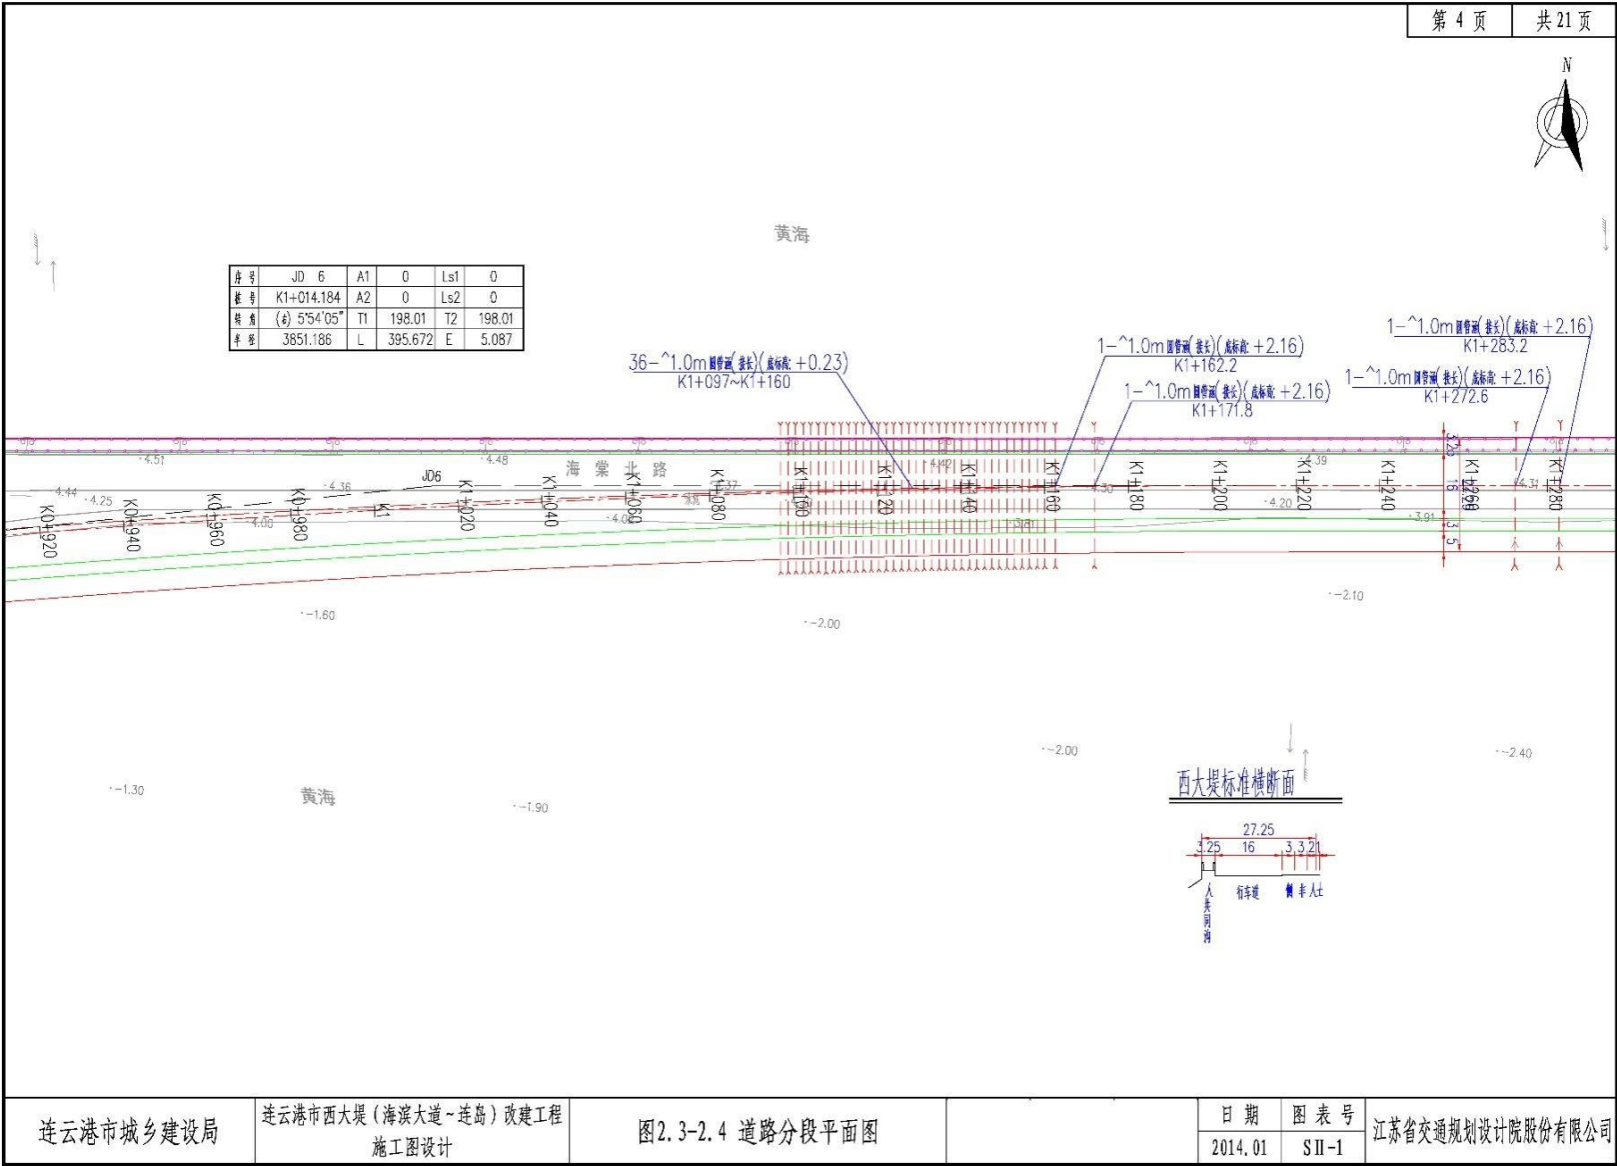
道路分段平面图（K0+900~ K1+280）
